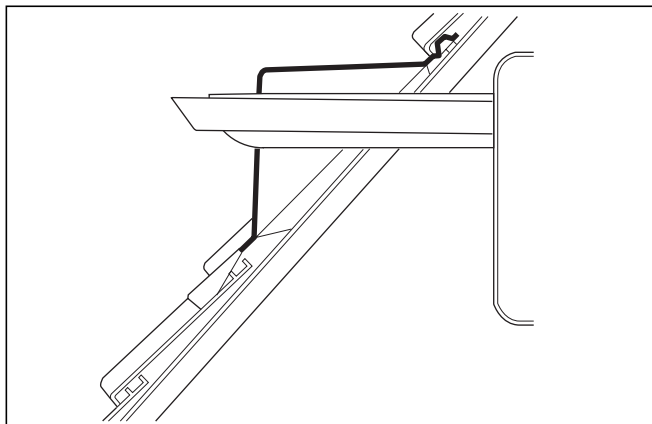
Пример монтажа горизонтального прохода через крышу (четырёхугольное слуховое окно)
